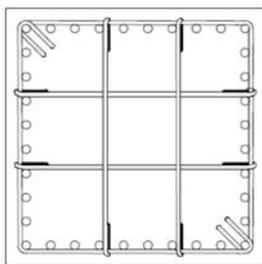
中間帯鉄筋の配筋例（道示IV編，図-解 5.2.1）
